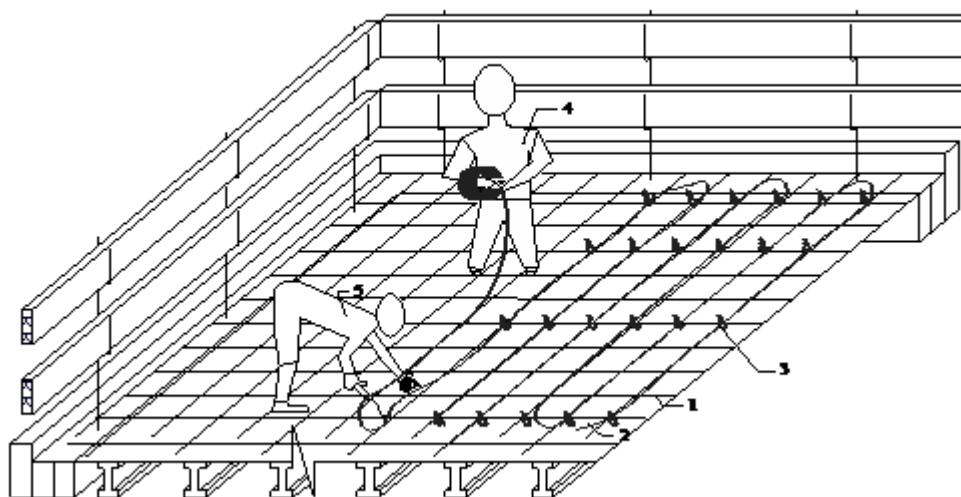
Схема укладки греющего провода: 1 стержень арматурной сетки;
